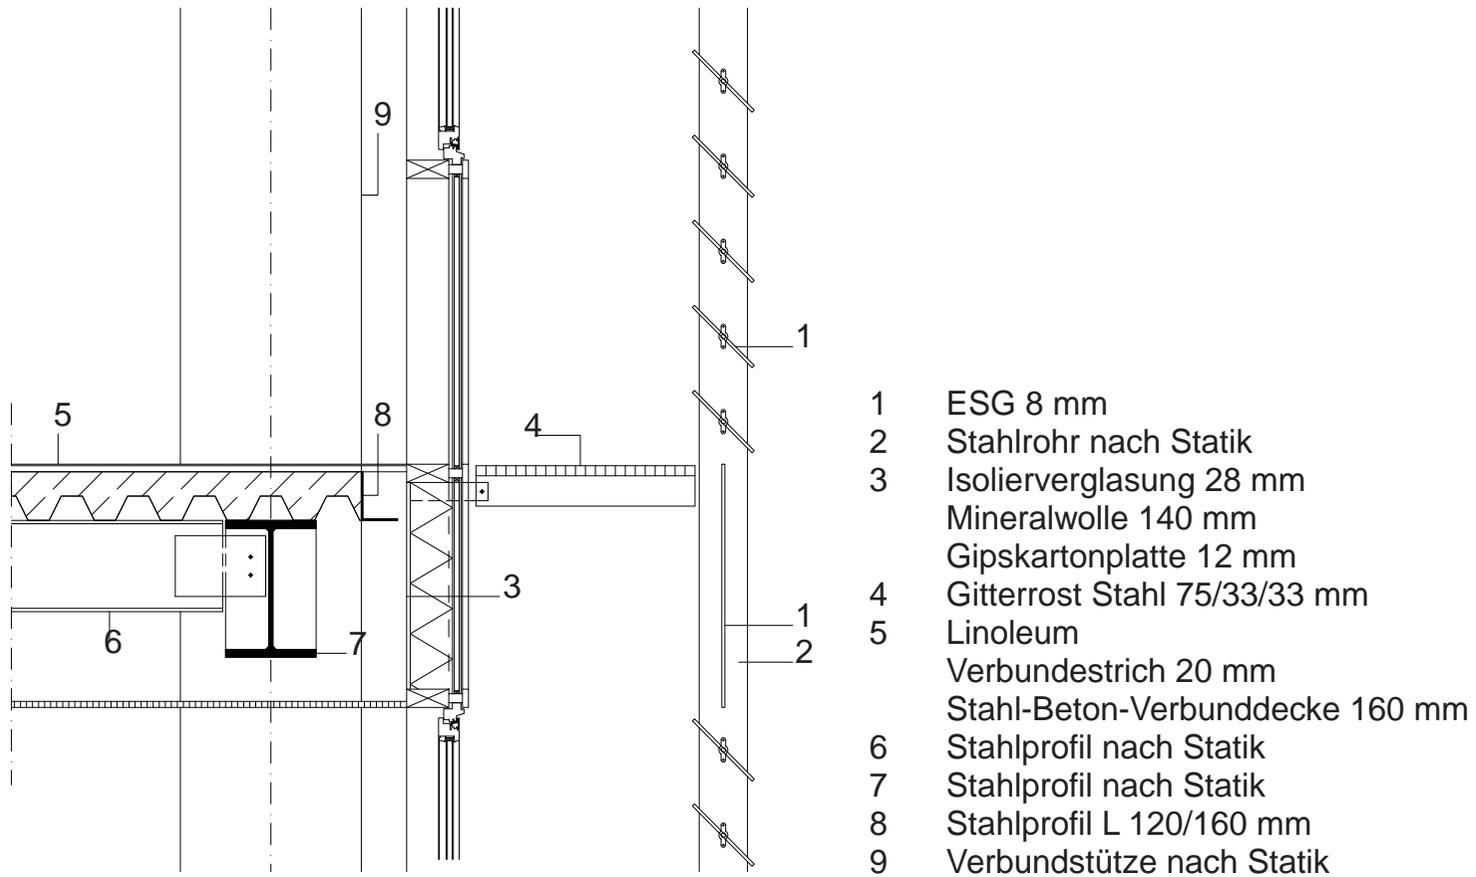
Fassadenschnitt, Anschluss Fassade an das Deckensystem
